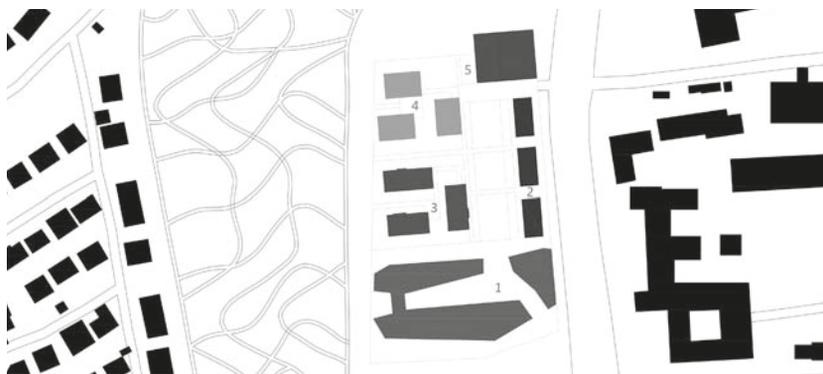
Stralcio planimetrico del quartiere con indicazione dei progettisti: 1. e 2. O&O Baukunst; 3. KCAP Architects & Planners; 4. be baumschlager eberle; 5. David Chipperfield Architects.
